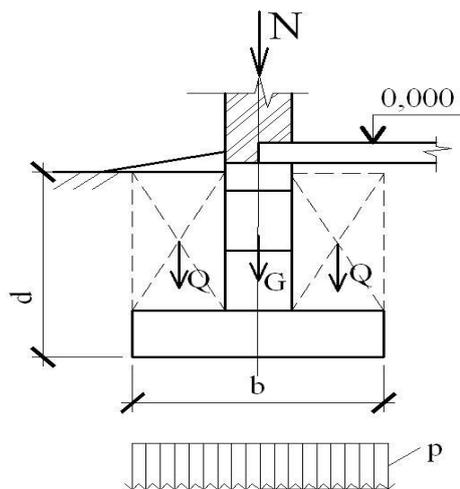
Расчетная схема центрально нагруженного фундамента
